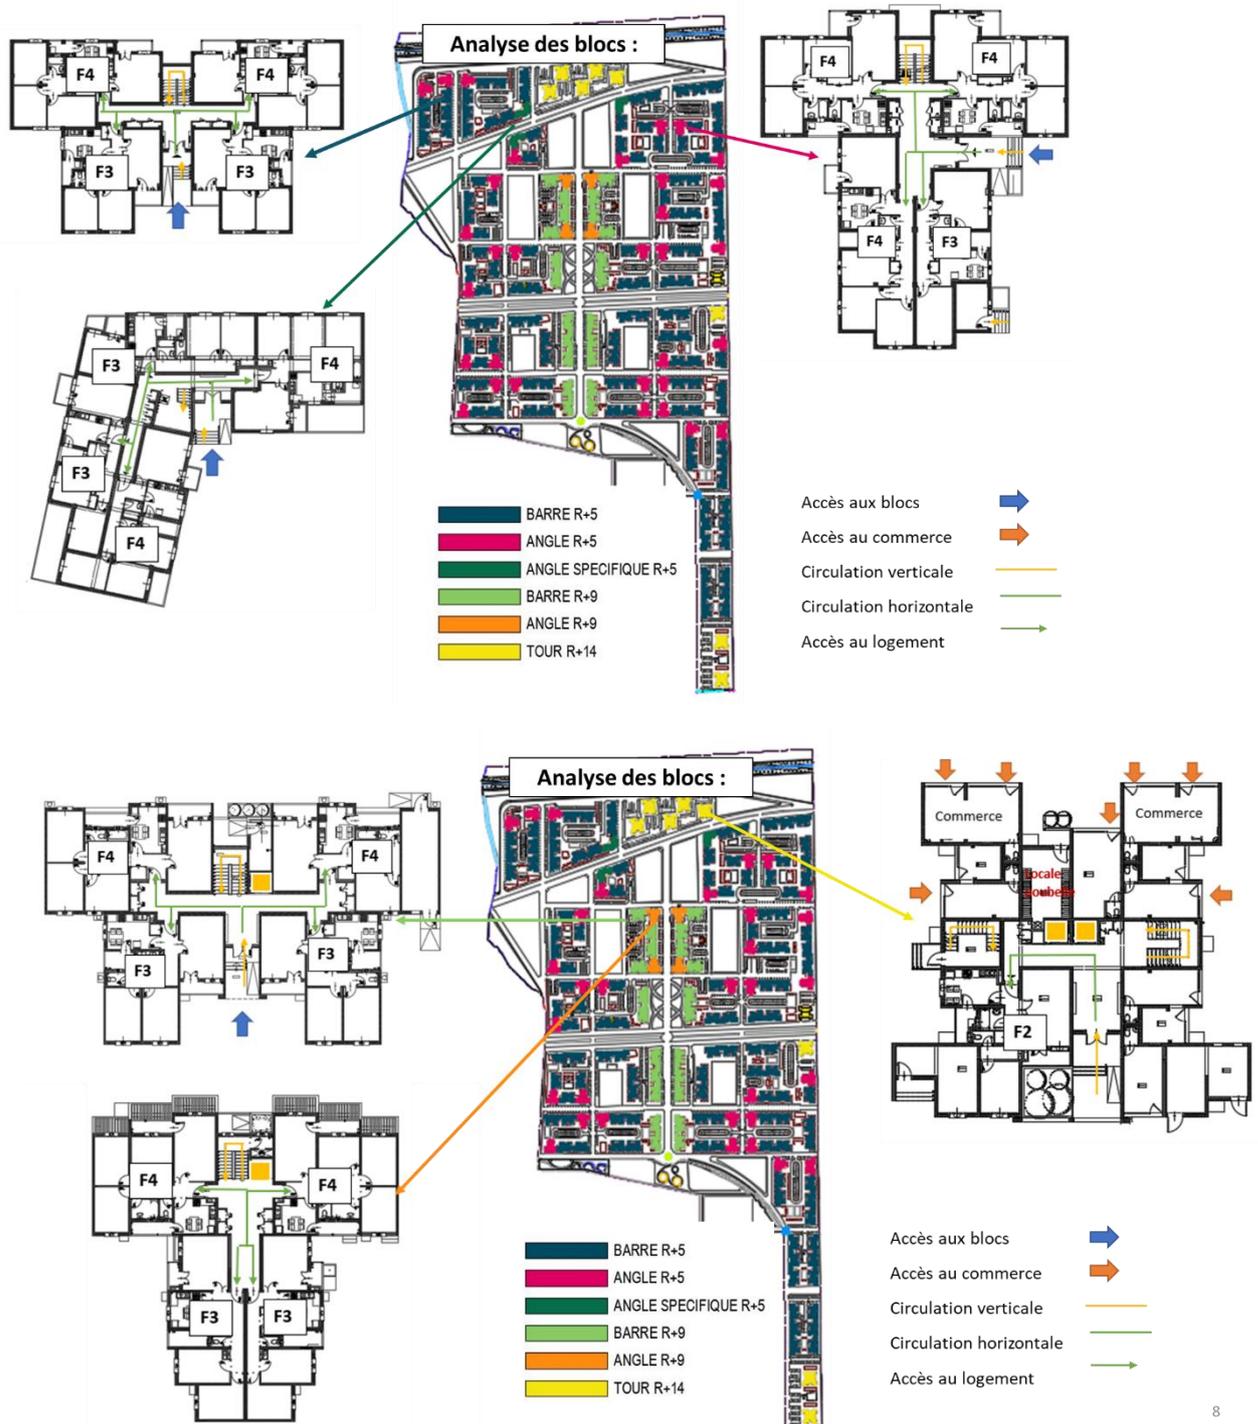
Plans des gabares de projet 5000 logement traité par l'auteur
